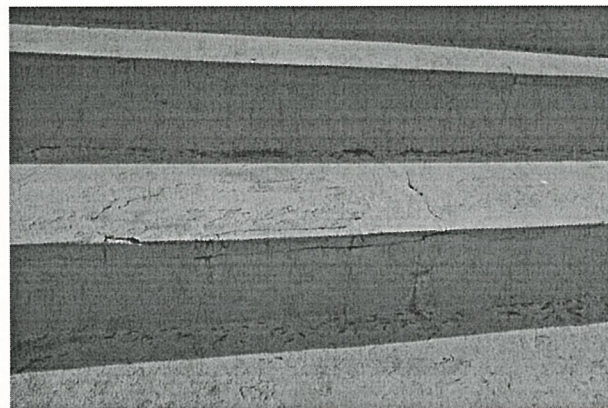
Strop „trybun schodkowych” , korozja zbrojenia
